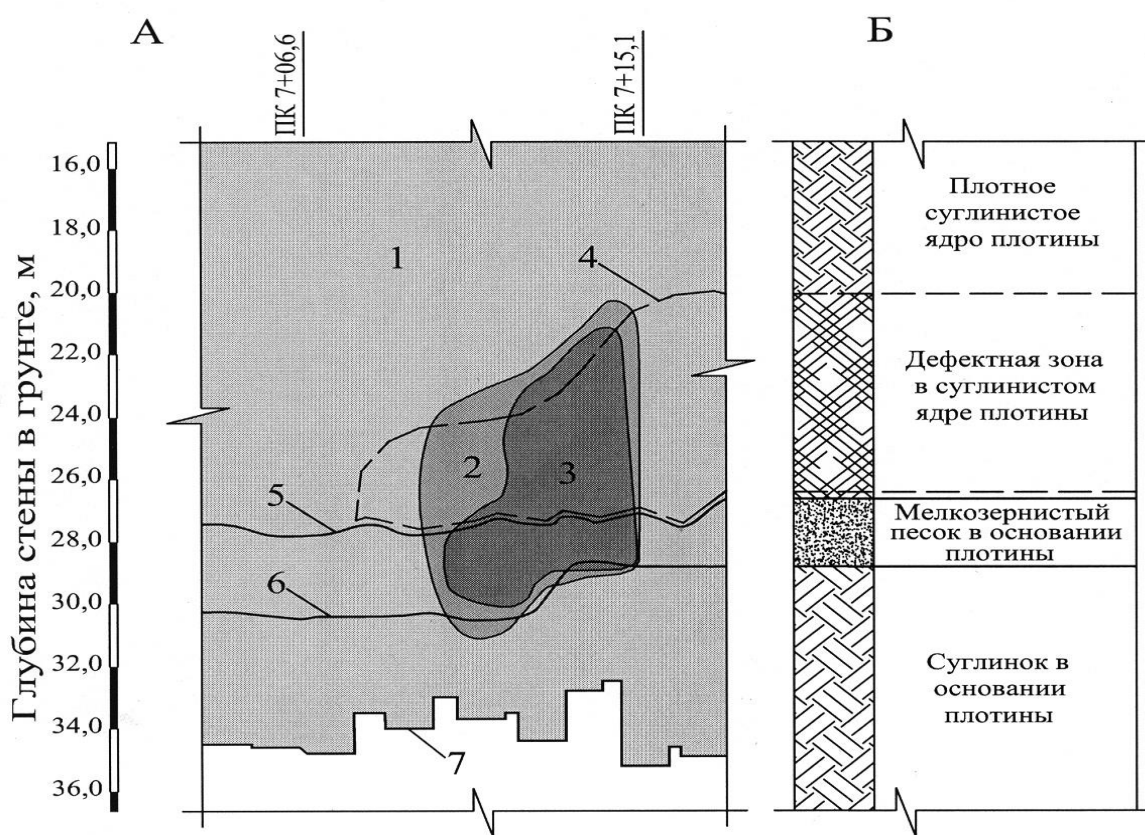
Продольный разрез по фрагменту стены в грунте:
